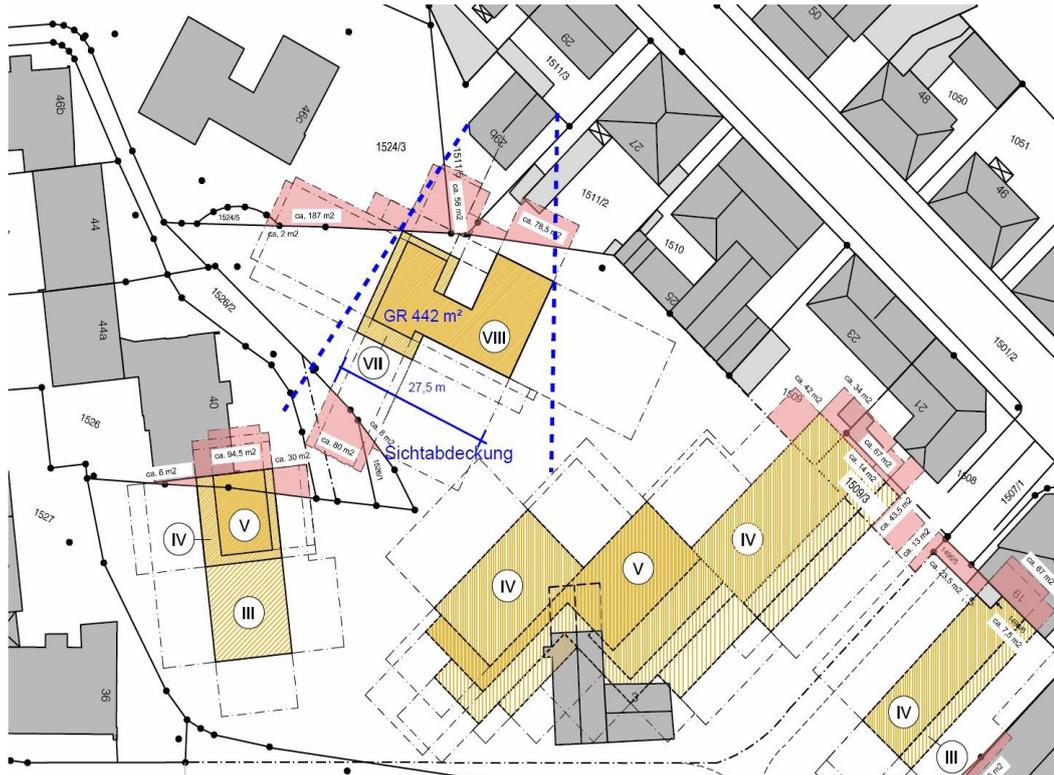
Auswertung Sichtabdeckung (blau gestrichelt) des rechtskräftigen Bebauungsplans, unmaßstäblich
